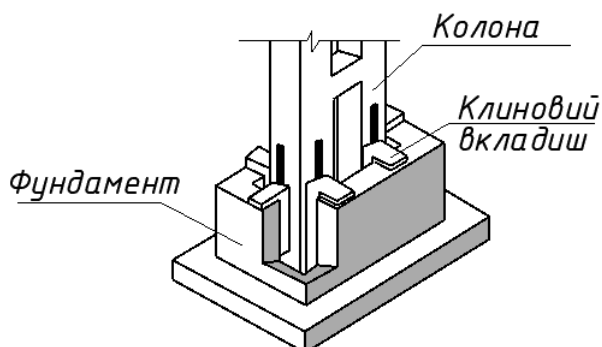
Спосіб тимчасового закріплення колони вкладишами
